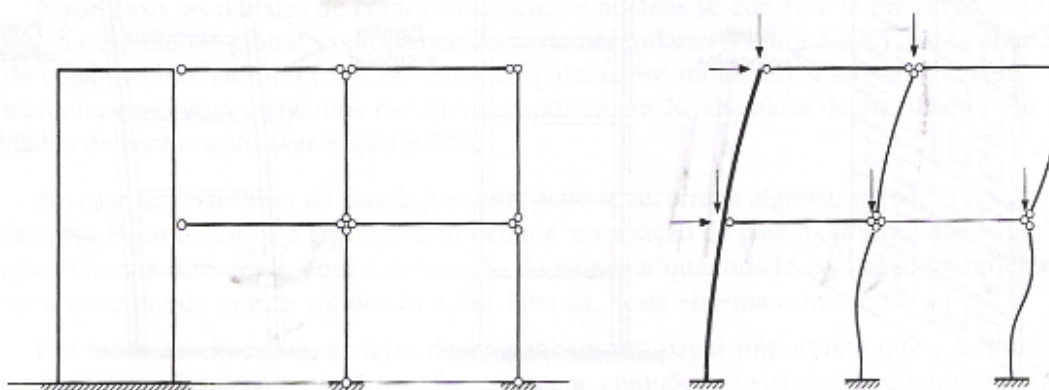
Pórtico articulado ligado a uma parede de contraventamento.
